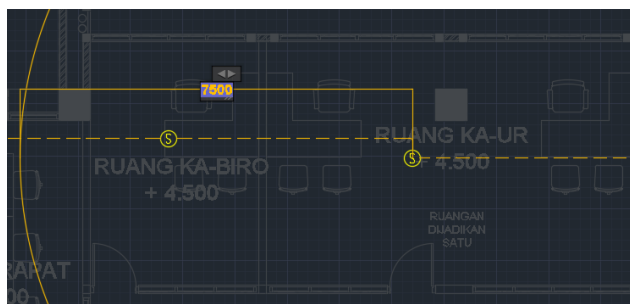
Denah Arsitektur Ruang KA-Biro
